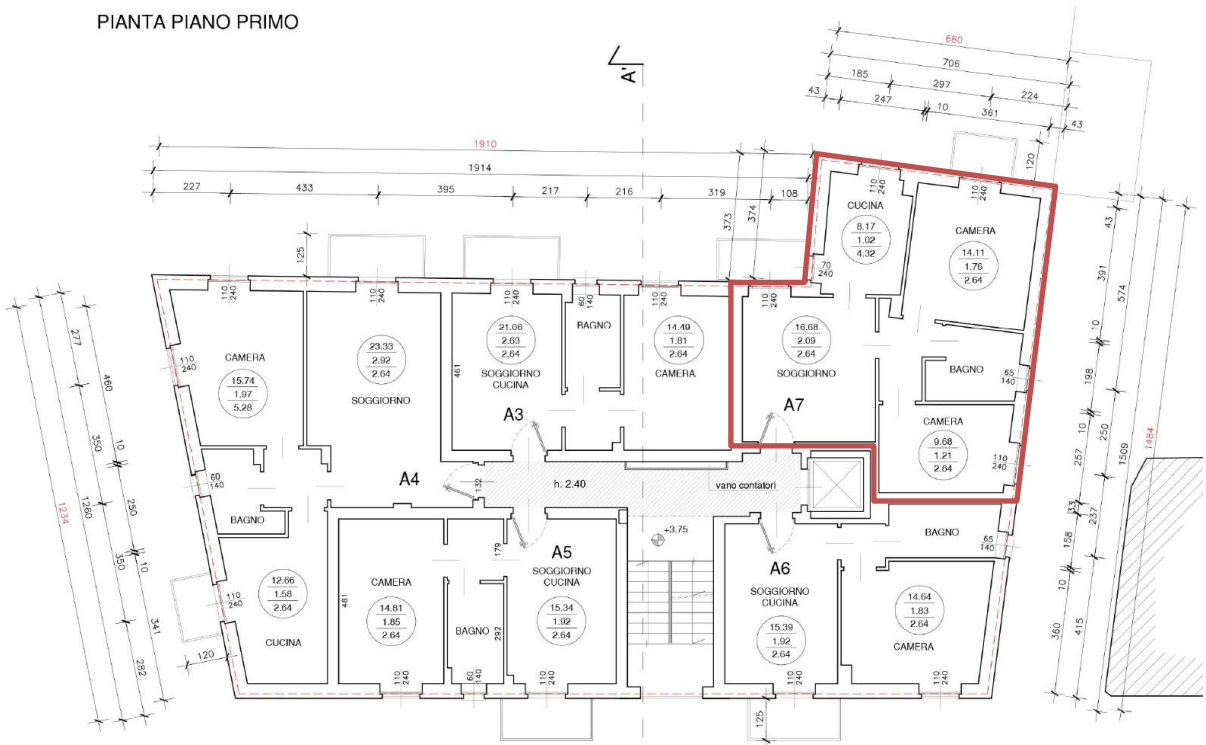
ESTRATTO PIANTA PIANO PRIMO SCIA N. 5709 DEL 2019
